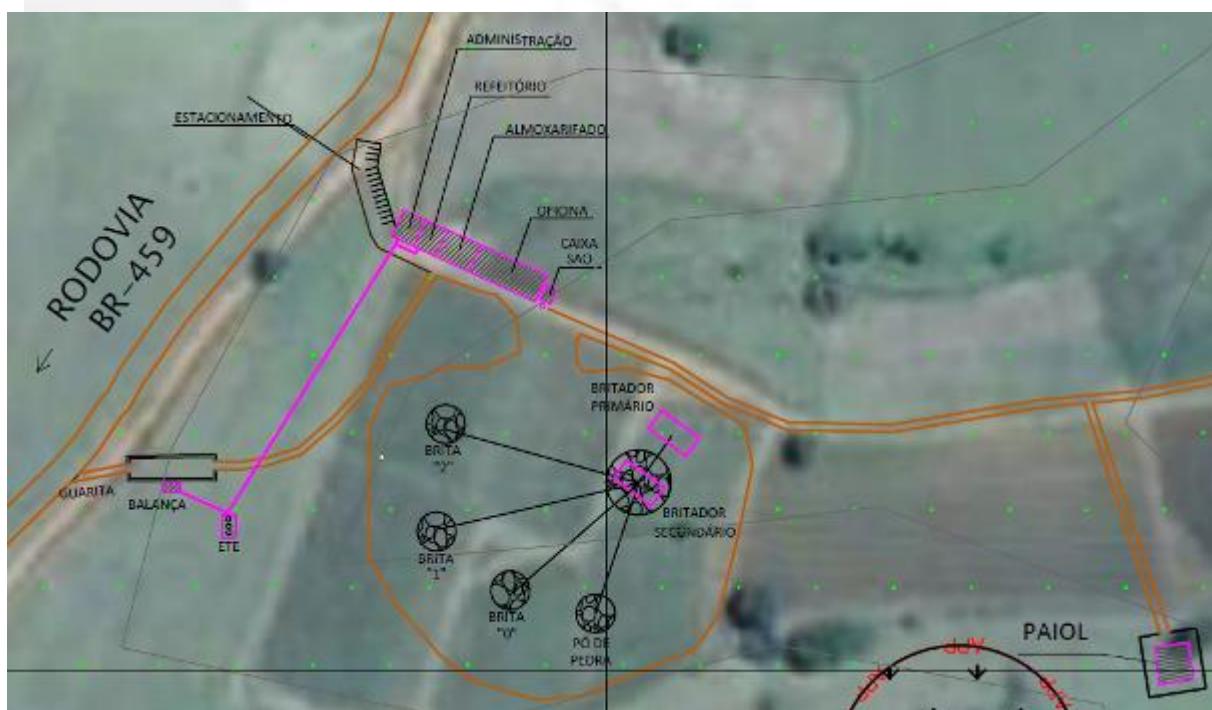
Detalhe da planta de beneficiamento e áreas de apoio
